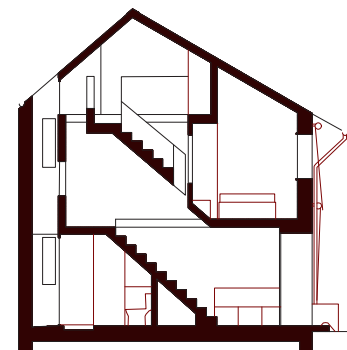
Secção tipo B Ilha da Bela Vista - LAHBSocial
